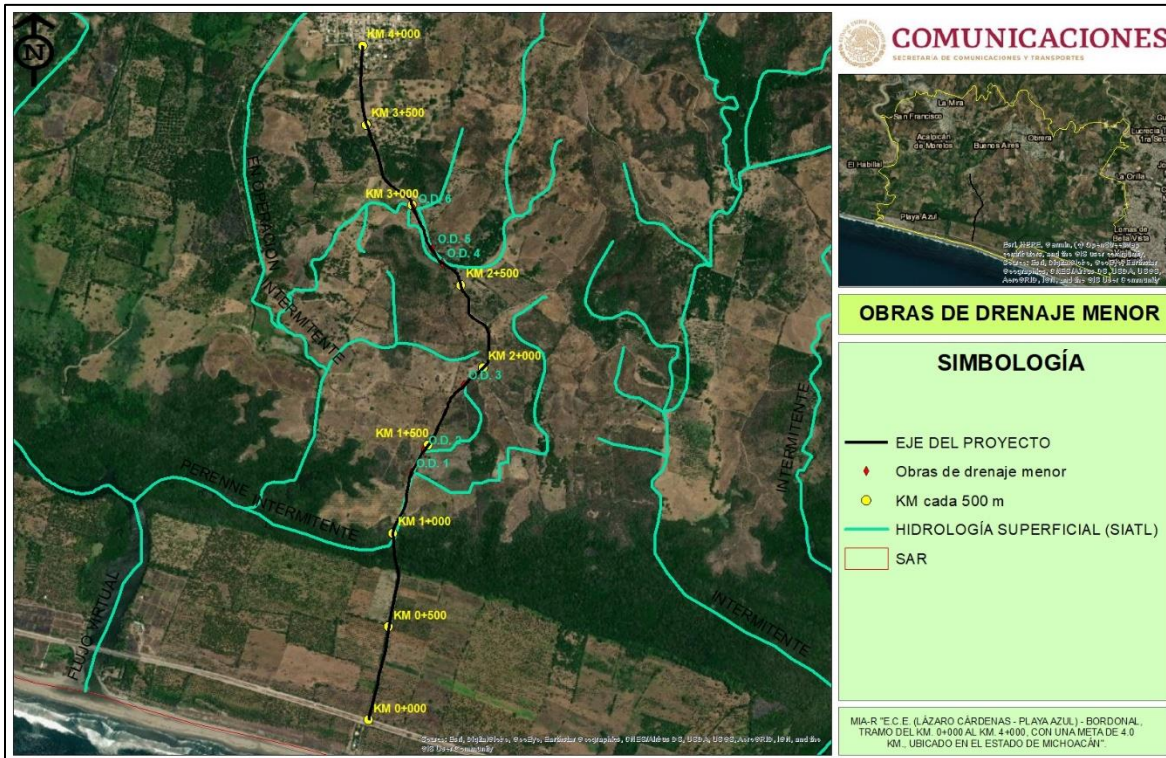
Obras de drenaje menor propuestas para el proyecto.
